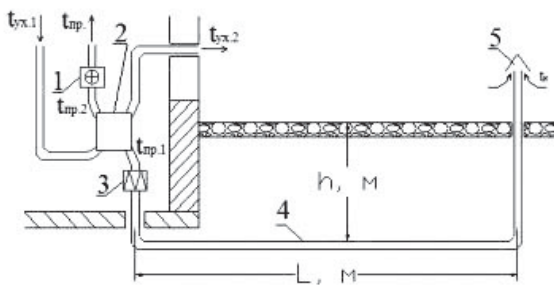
Принципиальная схема вентиляции здания с утилизацией тепла грунта и вытяжного воздуха
